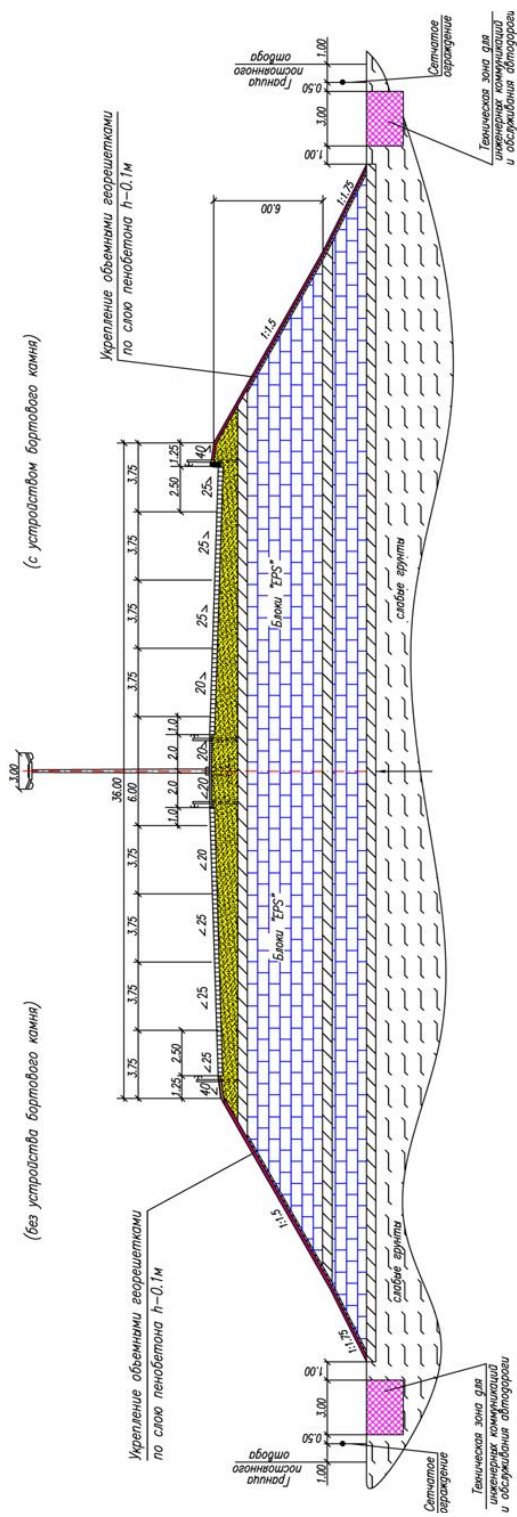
Поперечный профиль комбинированной дорожной насыпи на слабых грунтах из ГРС-блоками и пенобетоном.
